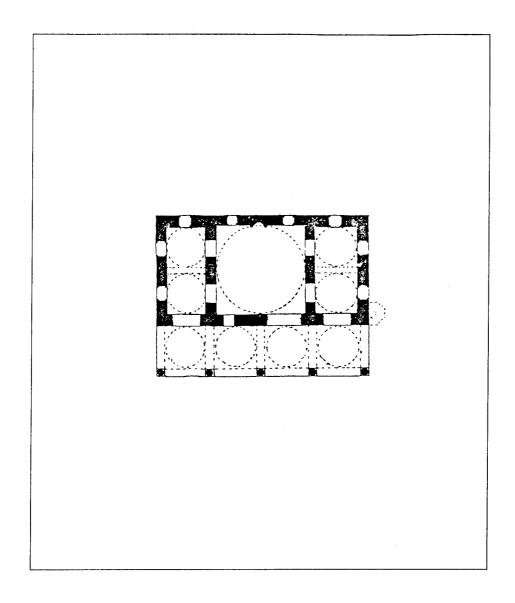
مسقط أفقي لمسجد اوج شرفلي في أدرنة (عن : ايفردي) .
